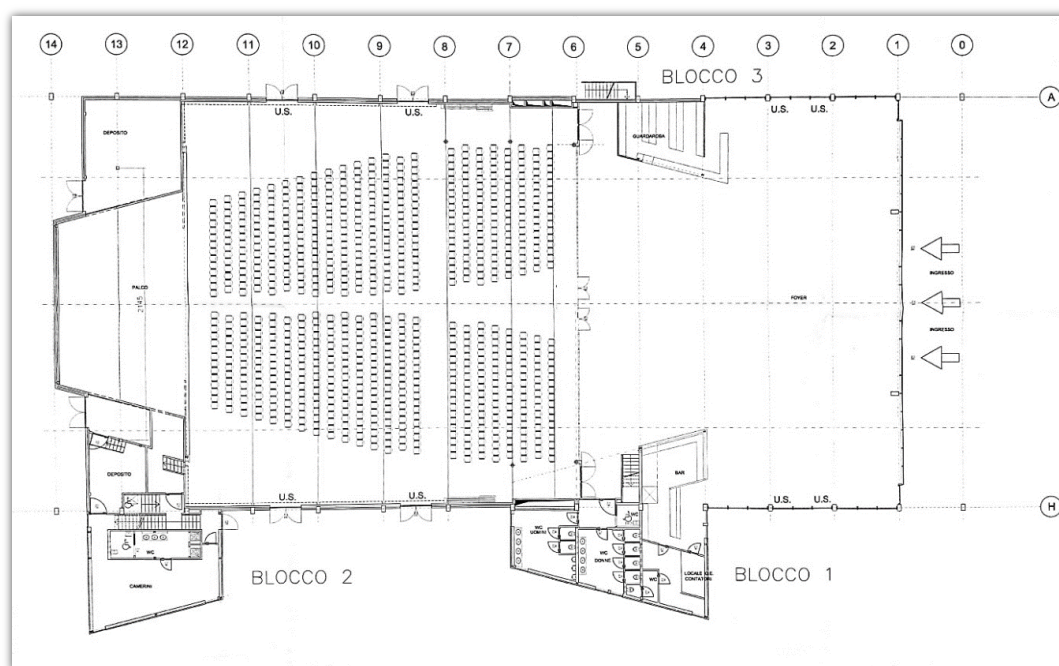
Teatro della Concordia, pianta piano terreno
